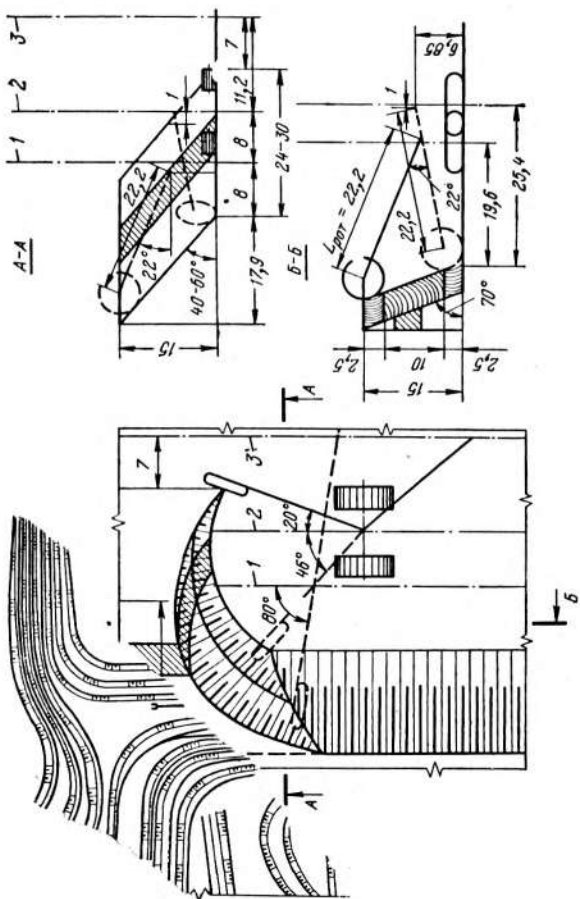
Схема отработки уступа с двух положений оси передвижения роторного экскаватора:
